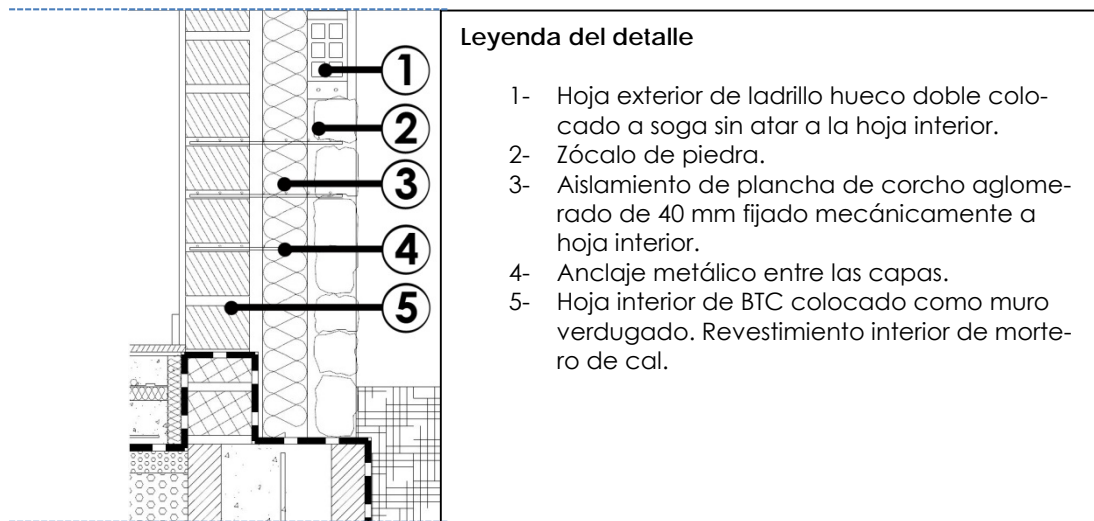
Anclajes en fachada (BAR-002). Fuente: David Pradas y Gabi Barbetá. Elaboración propia.
